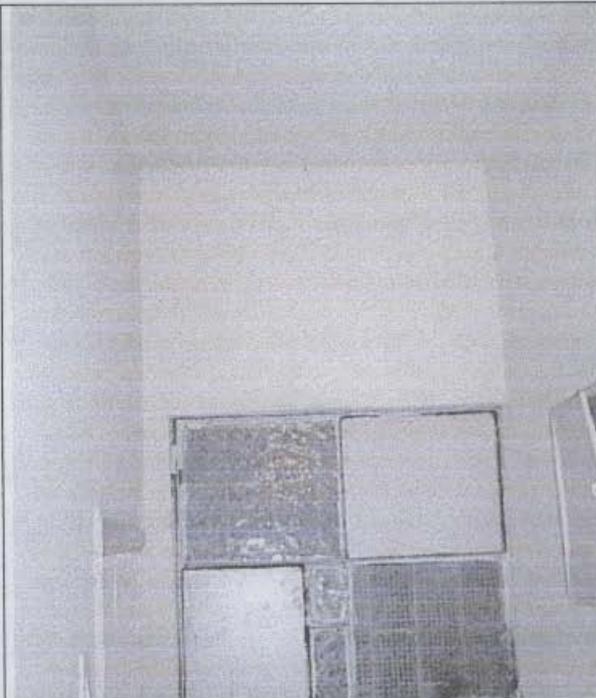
Vista interna de acceso por el costado norte del inmueble, sin daño estructural aparente.
